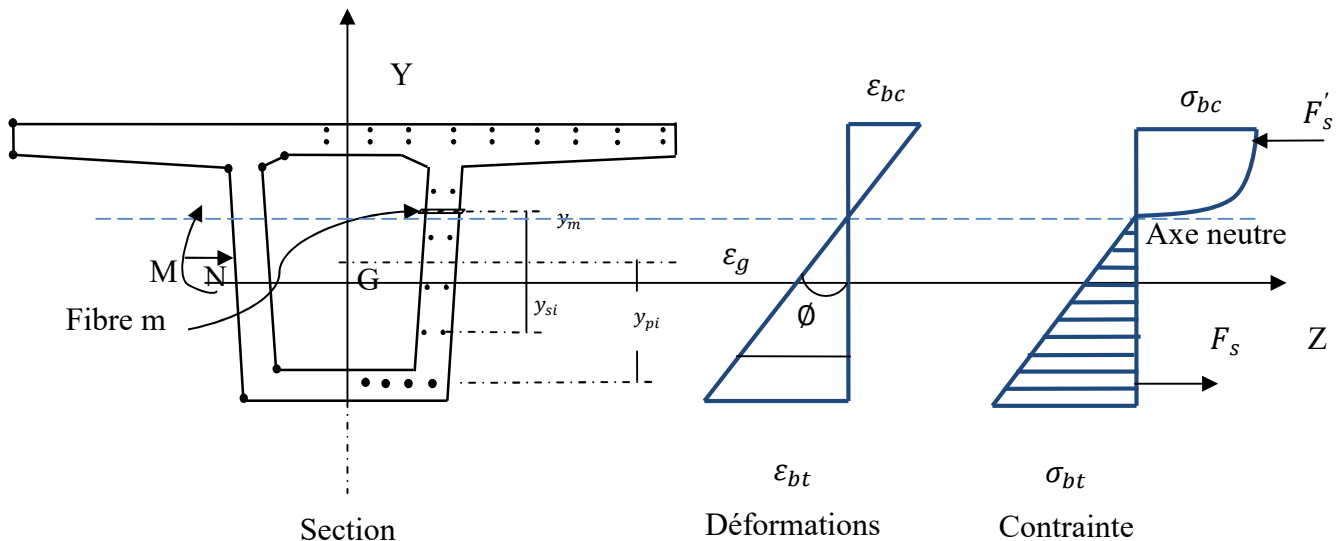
Description d'une section typique d'une section en béton armé et béton précontraint
